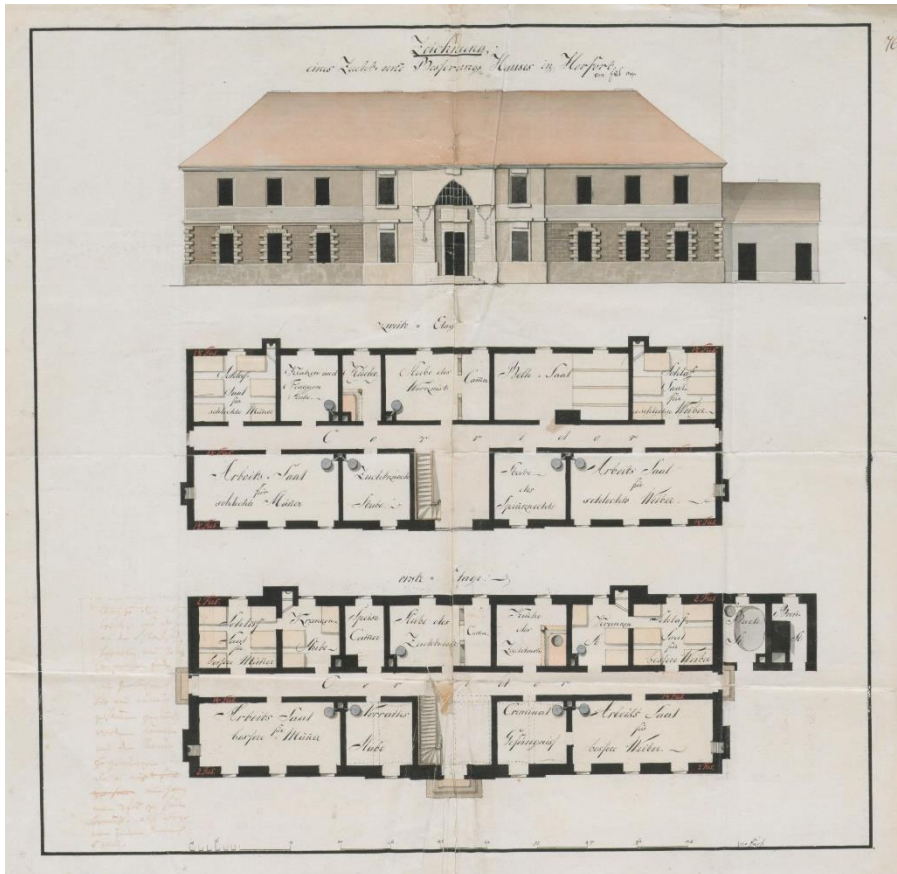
Das neue Zuchthaus am Holland, Front und Grundrisse
